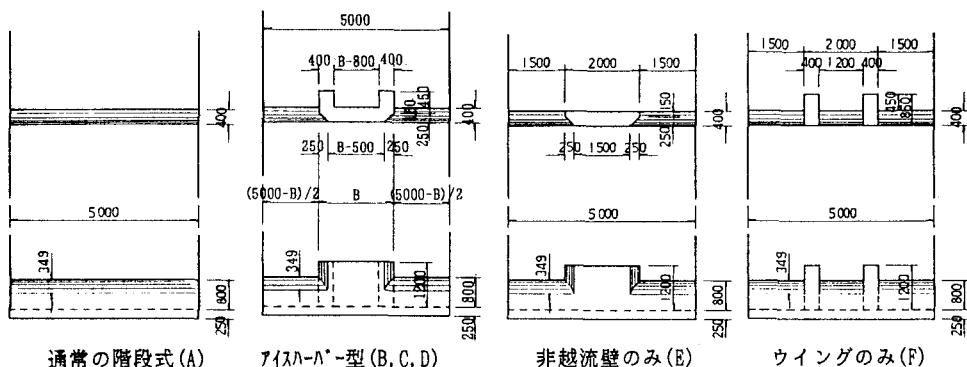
各ケースにおける形状寸法(単位:mm, 上:平面図, 下:下流面図)
